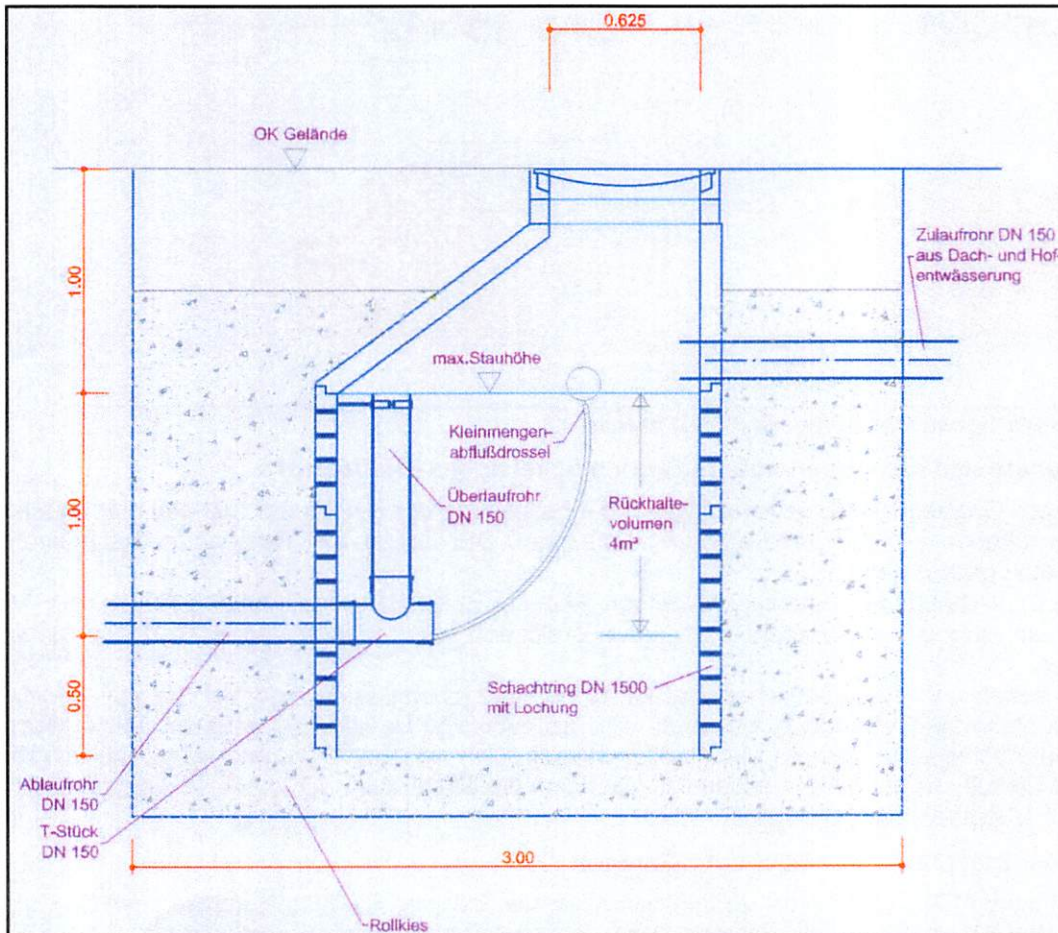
IB Lais, Mittelstetten, Systemschnitt Retentionsschacht
